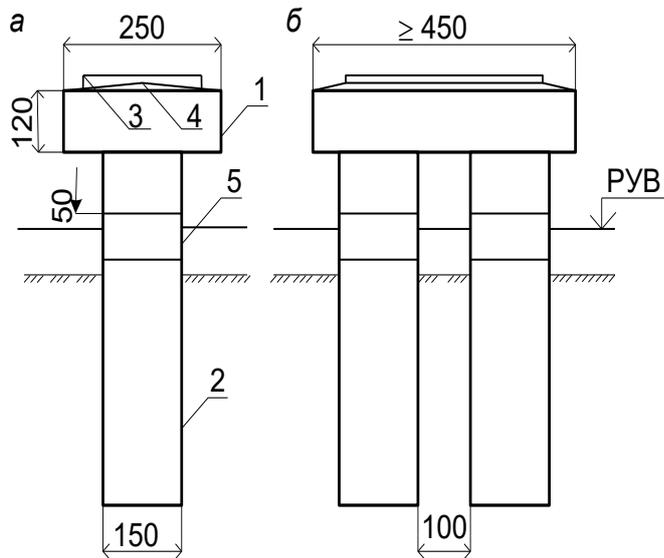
Промежуточная опора безростверкового типа на буронабивных столбах: а – вид вдоль оси; б – вид поперек оси моста; 1 – монолитная насадка; 2 – буронабивной столб; 3 – опорная площадка; 4 – сливная призма; 5 – металлический кожух; РУВ – расчетный уровень воды
